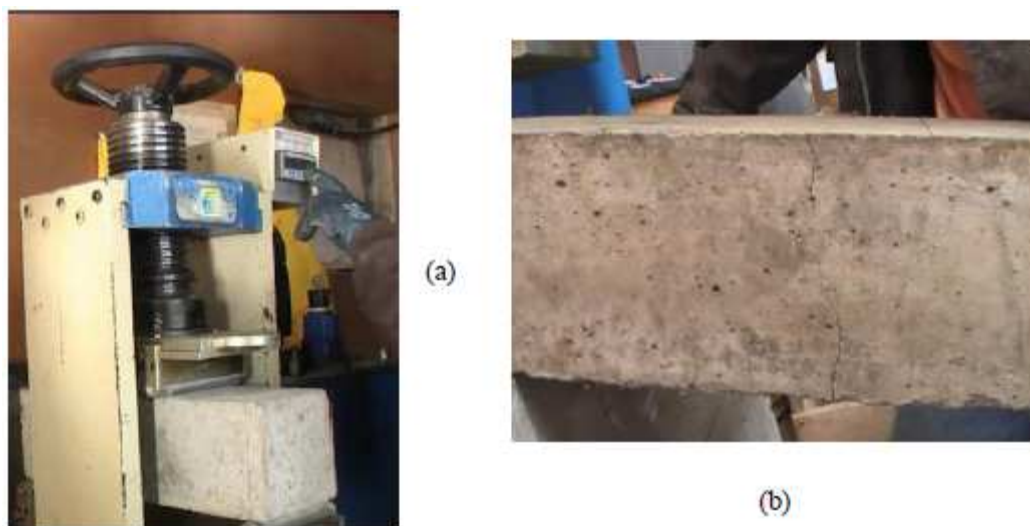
Rompimento à tração sob flexão de CP prismático (a) e detalhe do plano de fratura no concreto (b) (MAGALHÃES, 2009).
